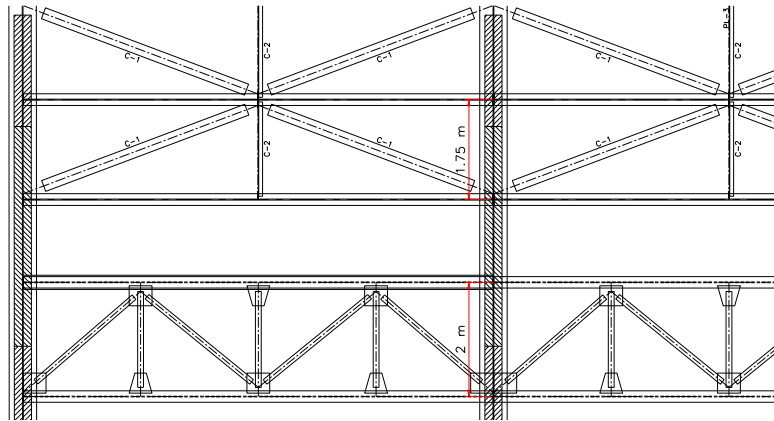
Vista parcial en planta del tramo levadizo, se observa la longitud libre de pandeo de los largueros transversales [4.3].
